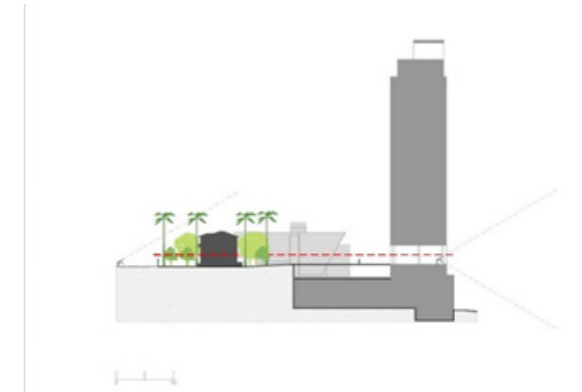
Corte esquemático do Edifício Praça Pamplona. Fonte: ArchDaily
